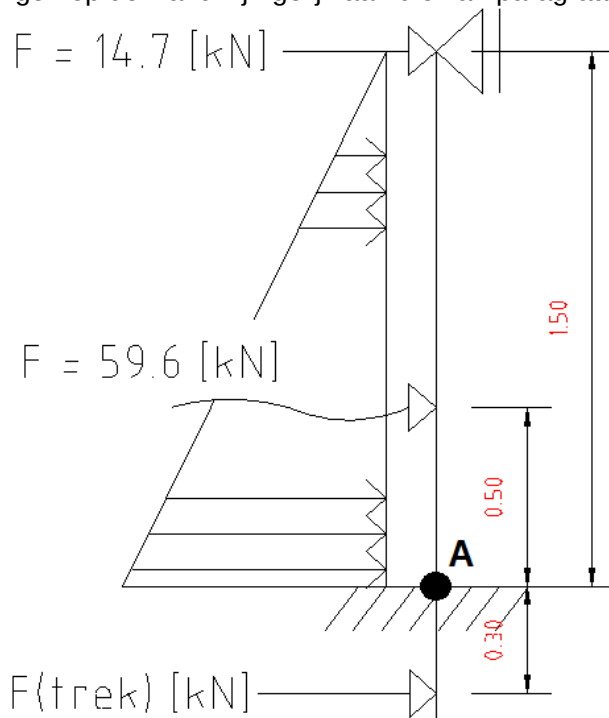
De inklemmingssituatie van de wanden in vooraanzicht
